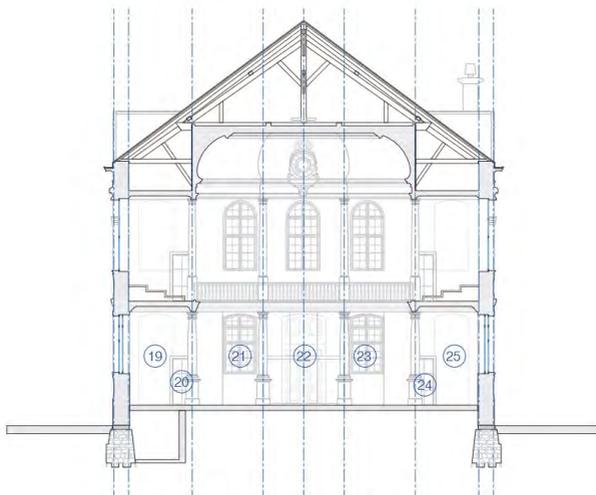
Coupe transversale, vue sur l'entrée principale.
